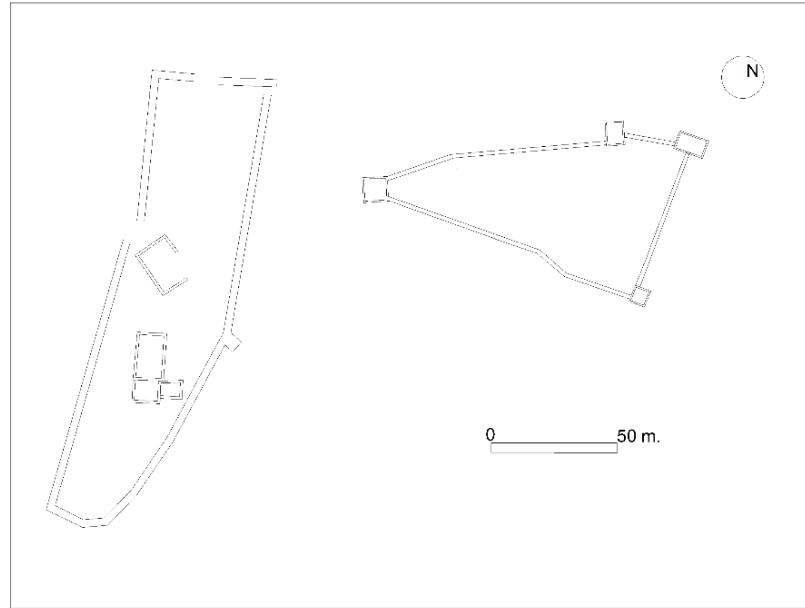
Edificio A3 en cabezo 3 de La Pendolilla y comparación con la planta de F. Arnold (2008) de la primera fase de la Alcazaba de Almería. Dibujo © Unidad Patricia UCO.
